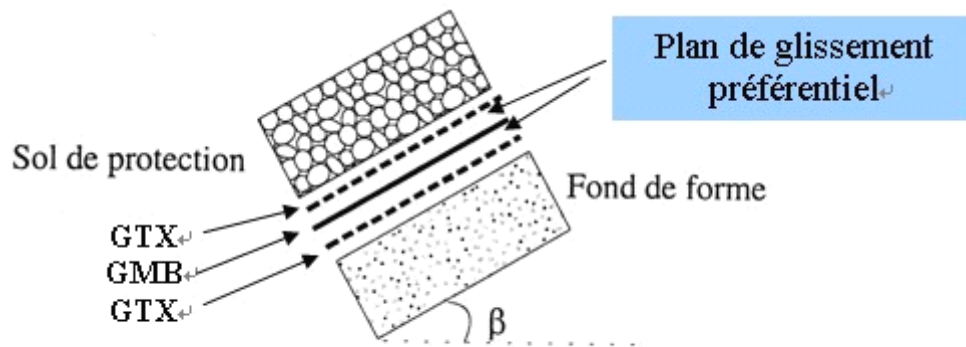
Cas type d'un DEG sur pente avec des plans préférentiels de glissement.
